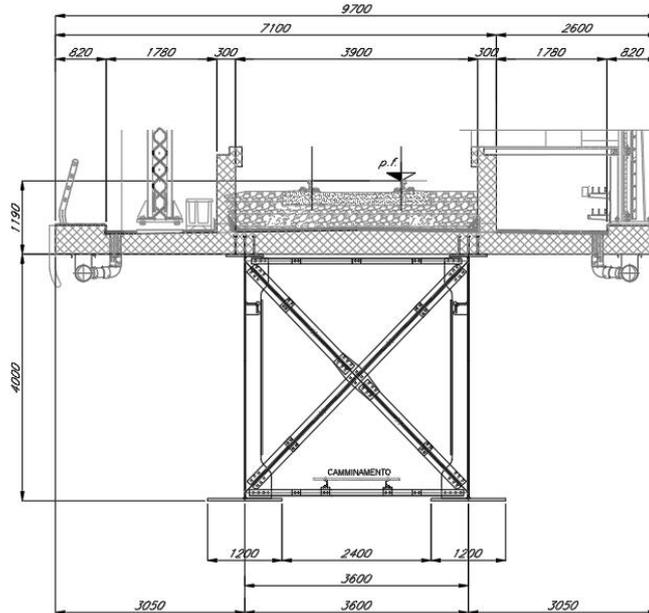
Sezione trasversale campate in acciaio-cls L=50 m
